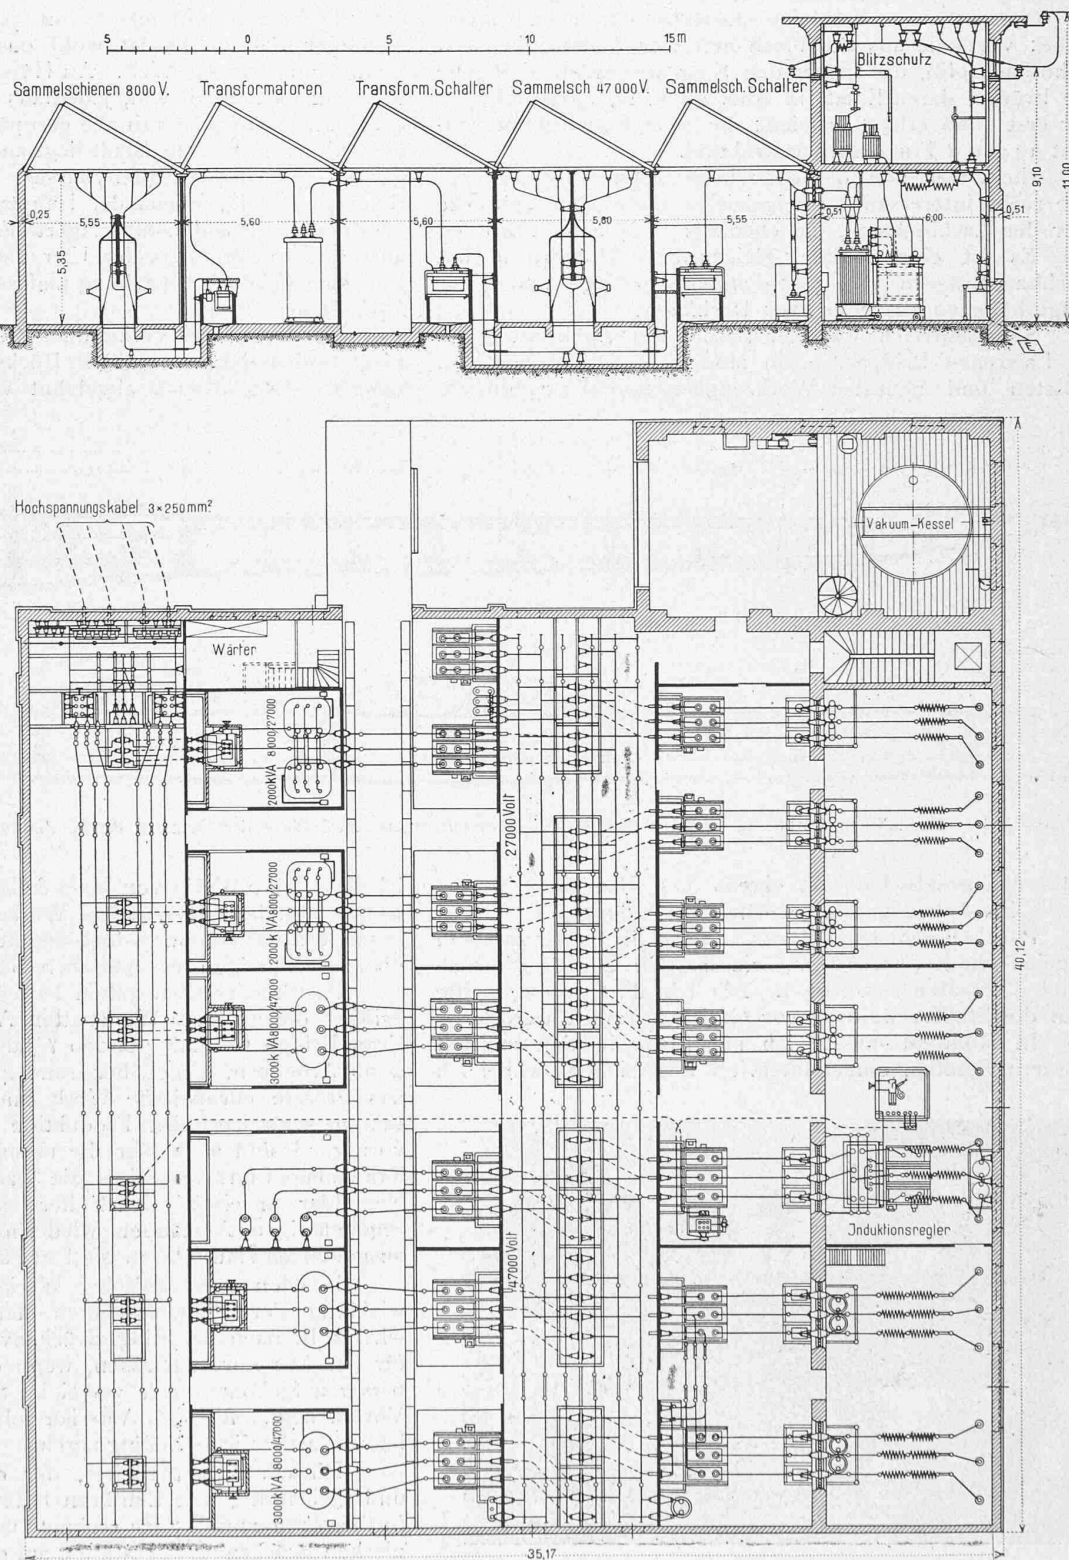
Schnitt und Grundriss der äusseren Schaltanlage. — Masstab 1:250.
